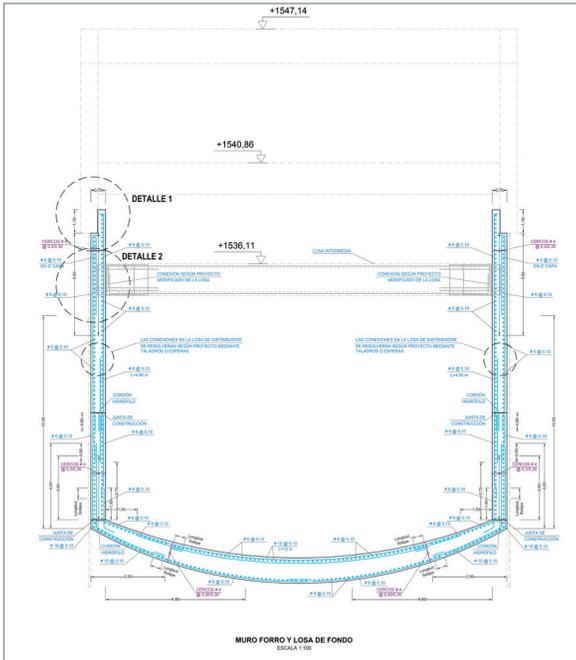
Sección de armadura de muro forro y contrabóveda.
